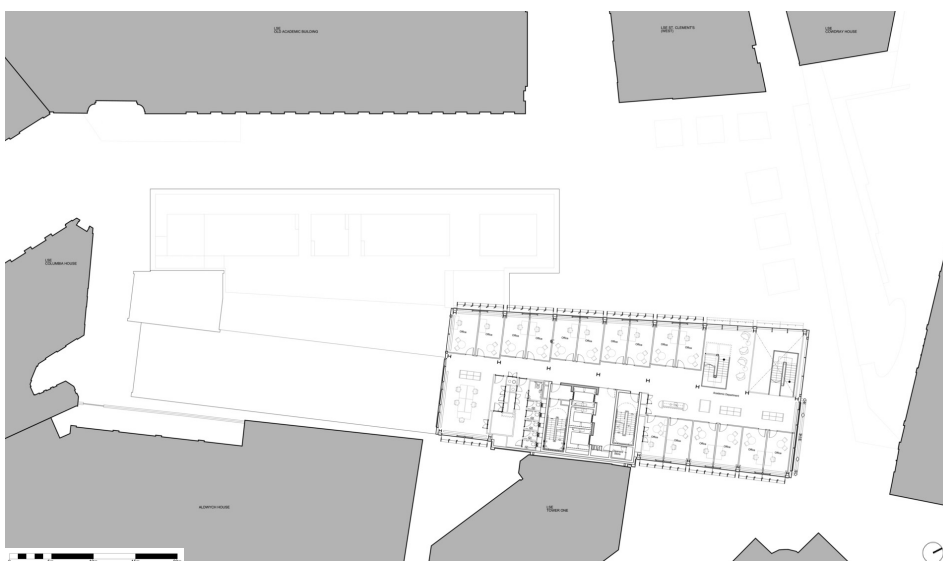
LSE Centre Building | Planta do 7º ao 11º Pavimento
